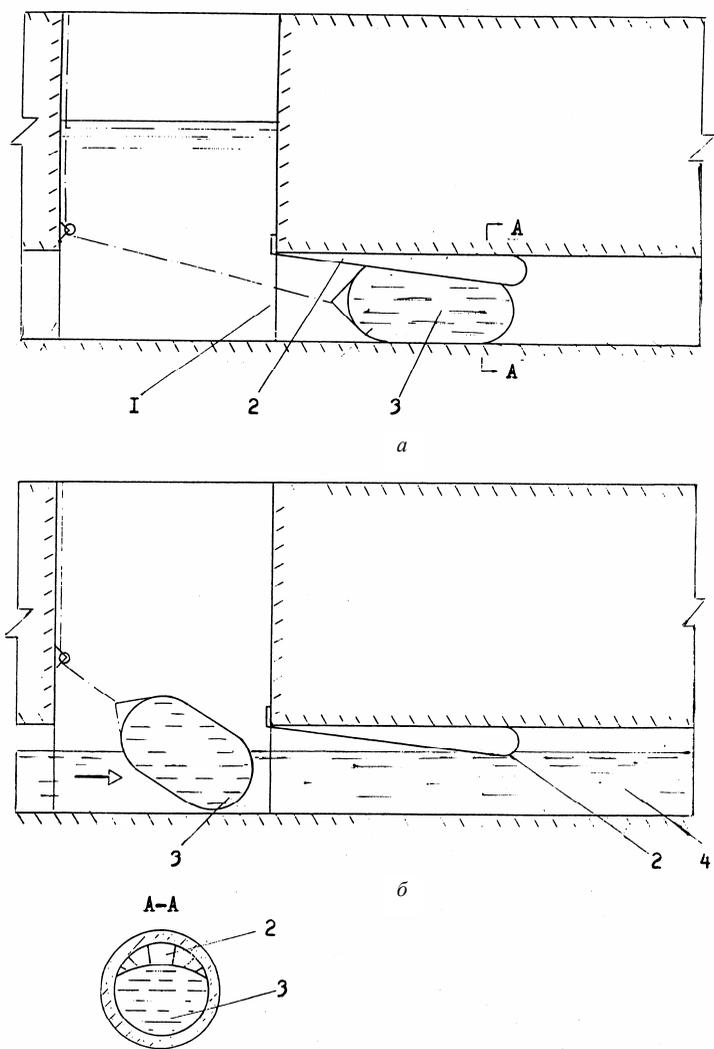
Мобильное затворное устройство для перекрытия безнапорных канализационных тоннелей
